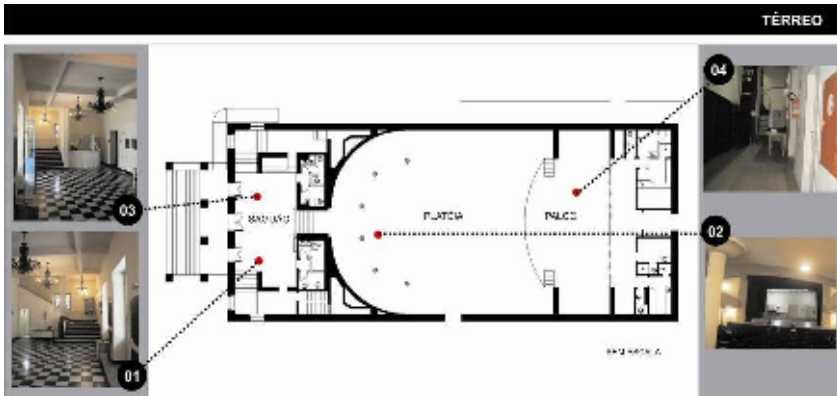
Pavimento térreo do TAC – platéia. Fonte: Autora (2009).
